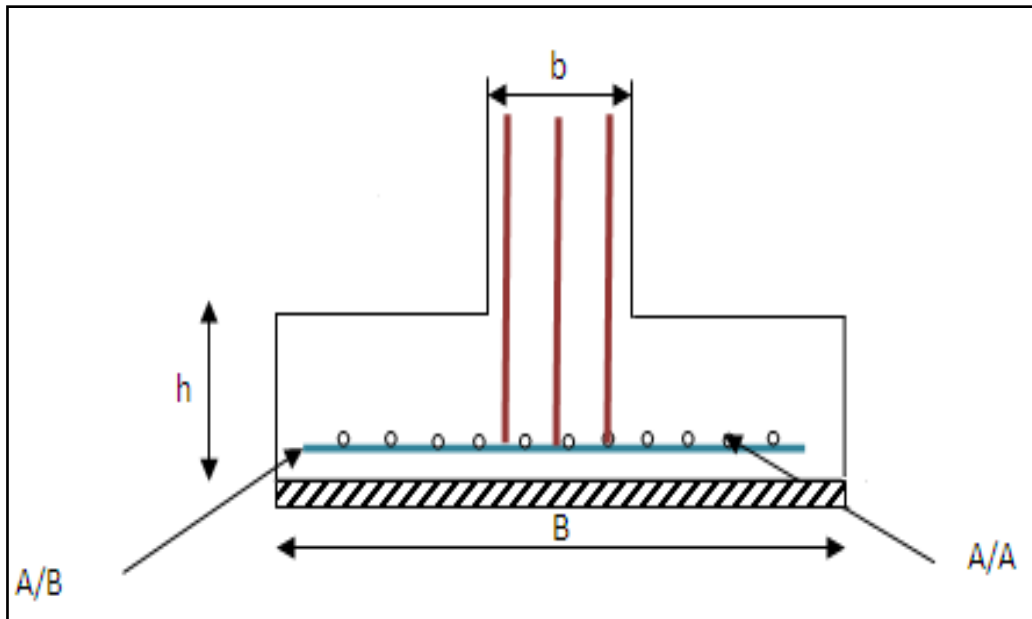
Ferrailage de la semelle isolée sous le poteau P2
